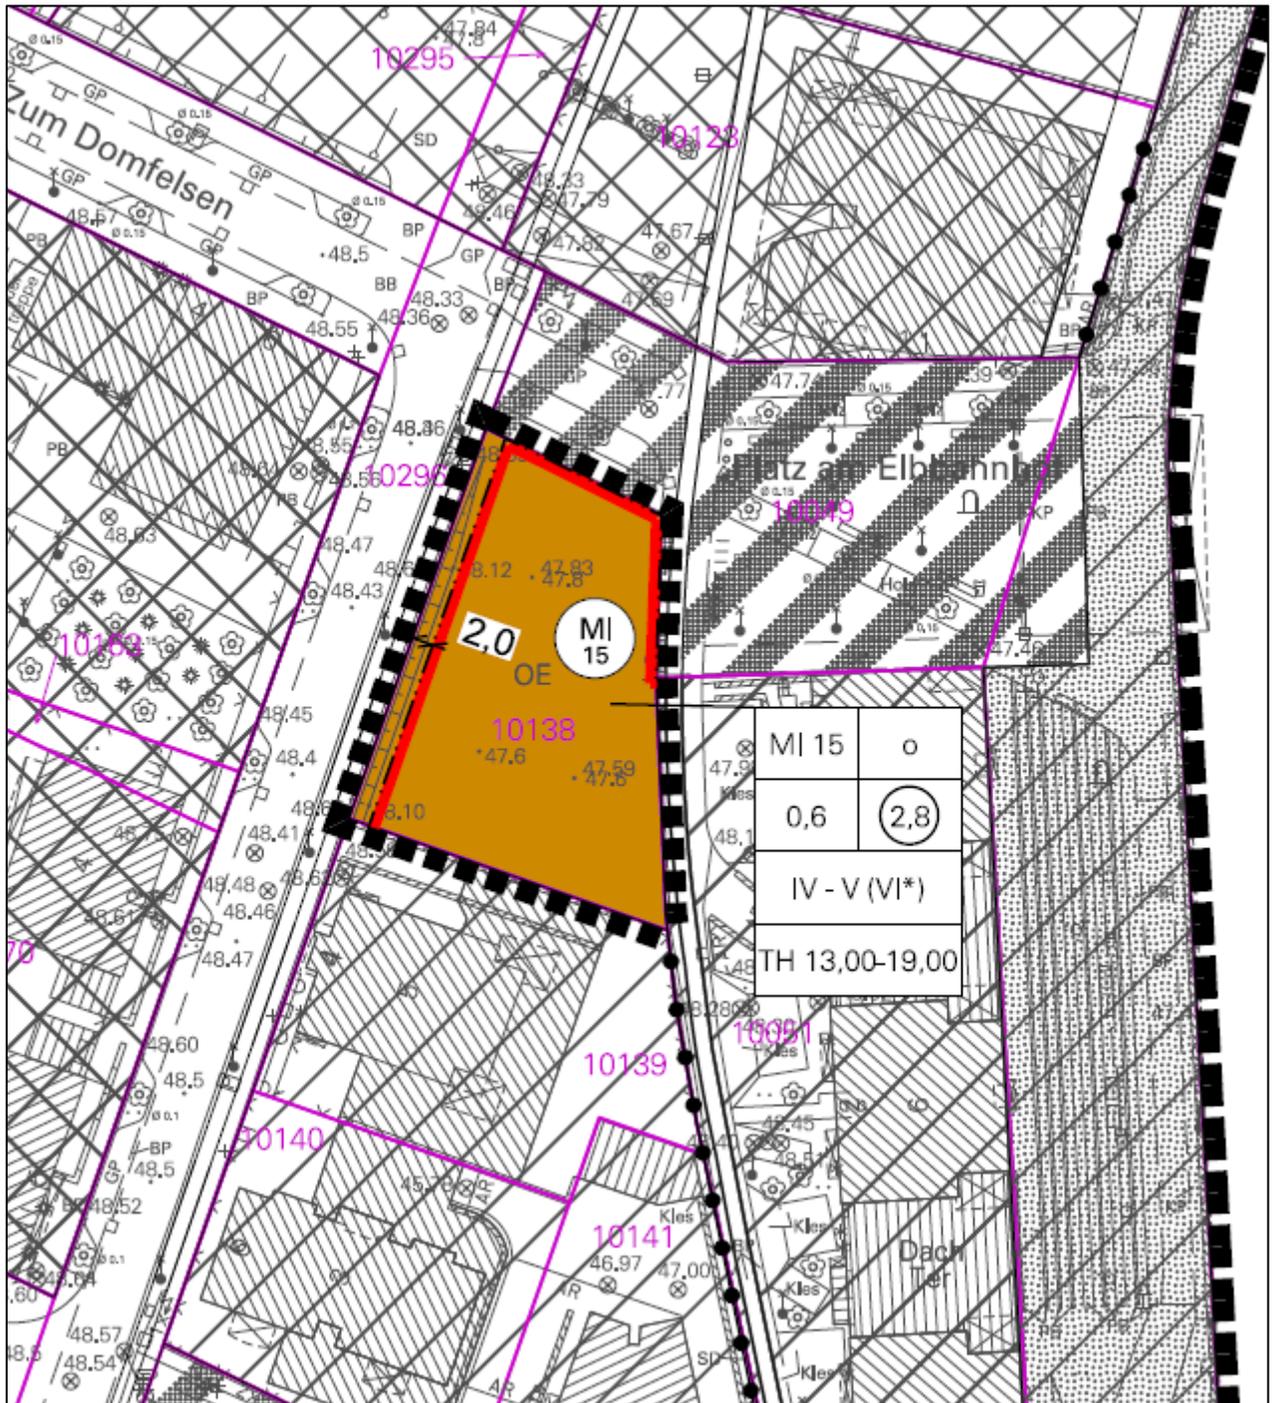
Ausschnitt – Planteil A in der Fassung der 5. Änderung B-Plan Nr. 242-1A
